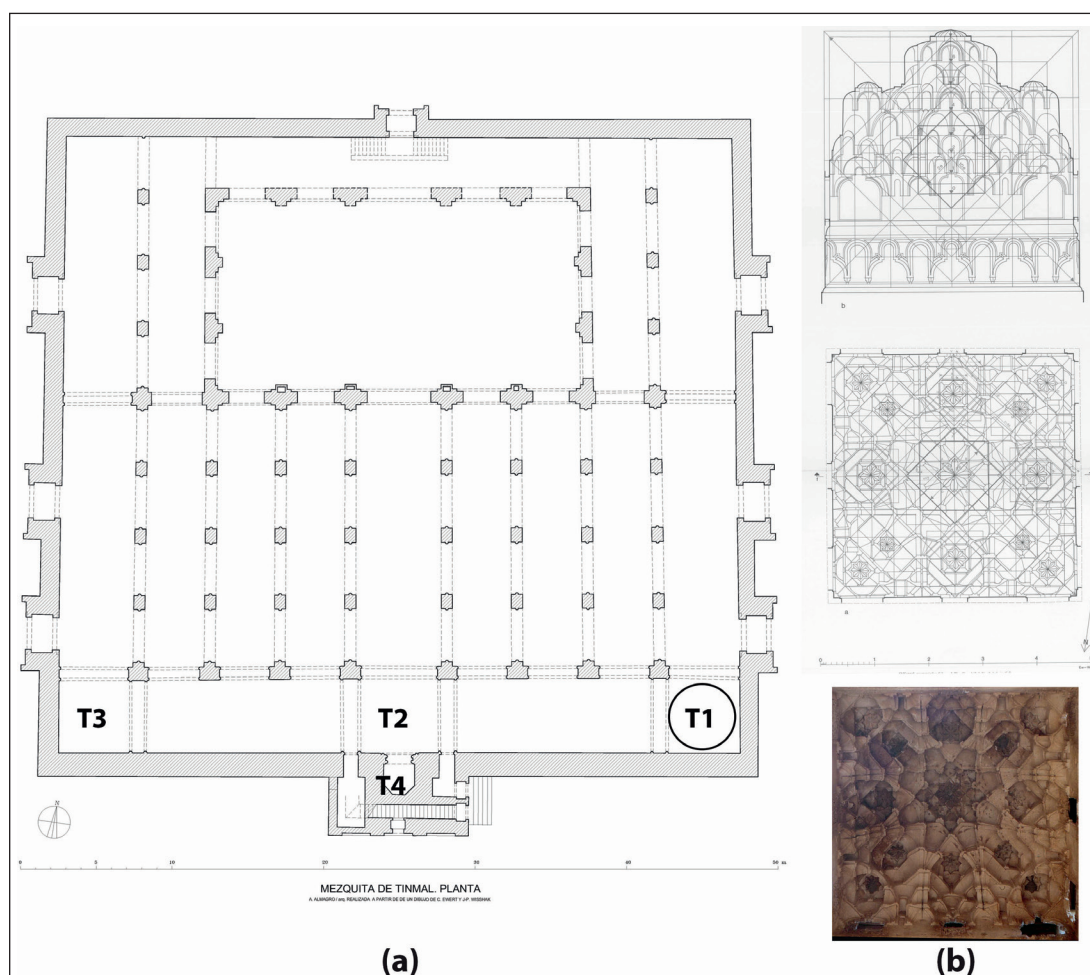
(a) Ubicación en planta de la bóveda T1 sobre el plano de la mezquita según Christian Ewert.
